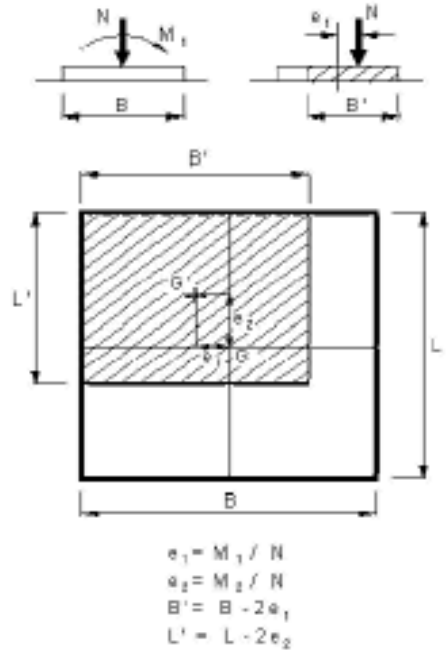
Fondazione efficace equivalente nel caso di fondazione rettangolare
